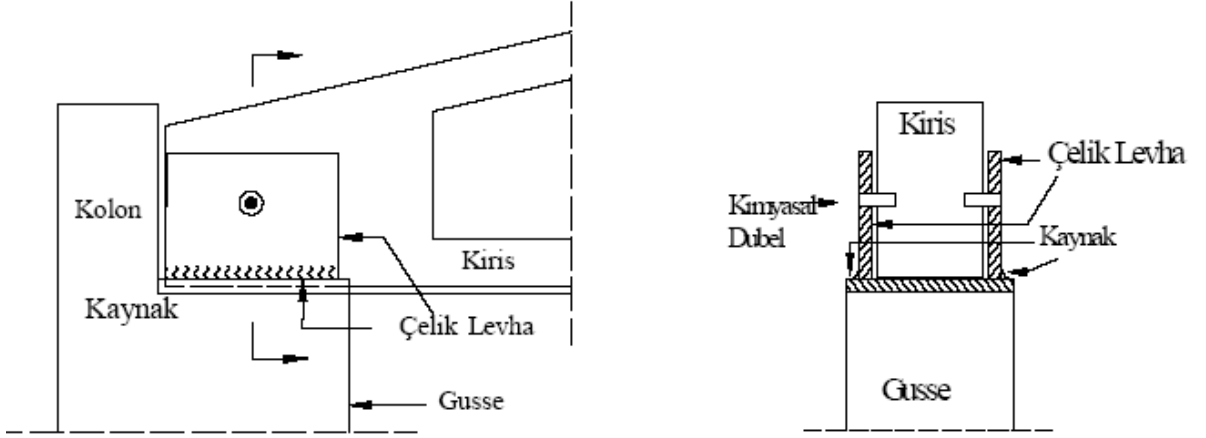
Kirişin Çelik Bir Yuvaya Oturması Ve Ortasından Geçen Bir Pimle Bağlanması
